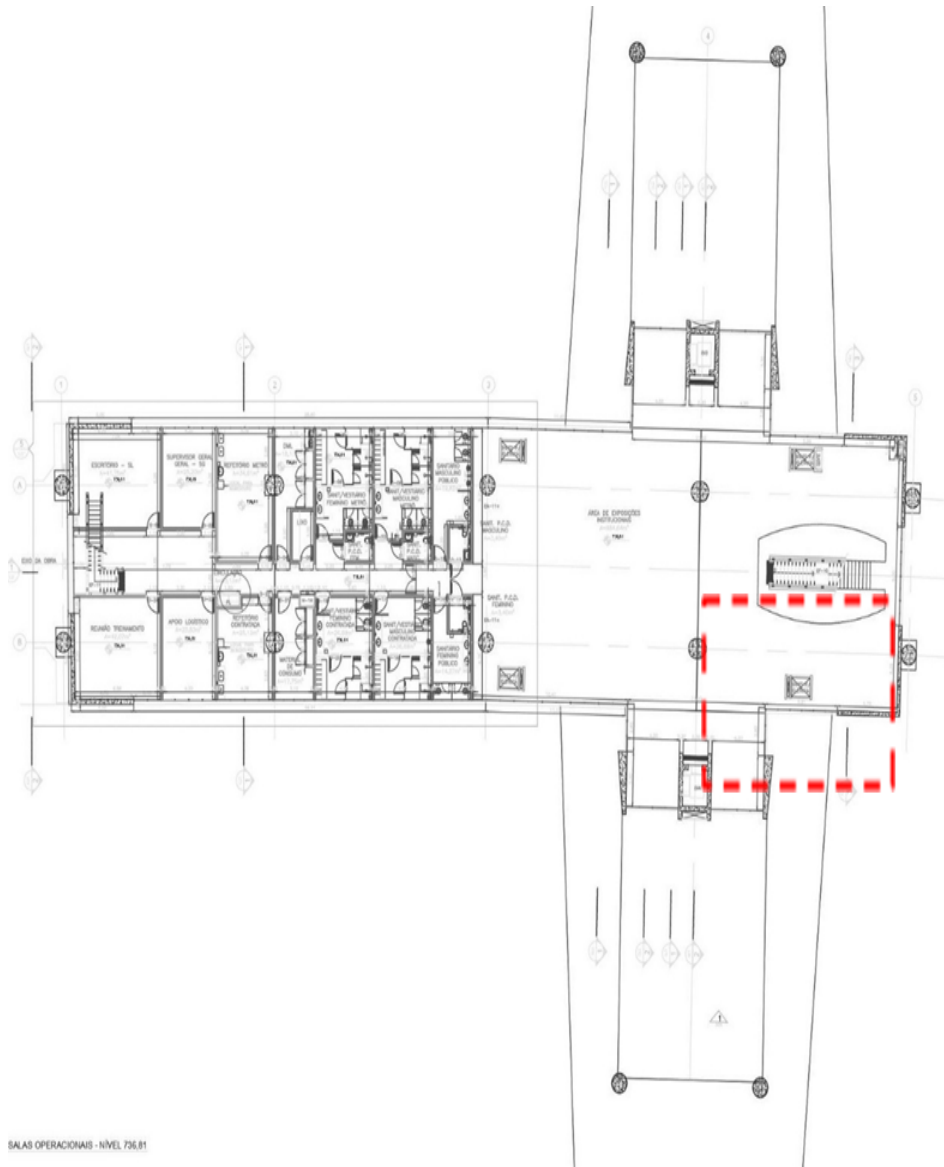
Demarcação da área de intervenção dentro do Pavimento das Salas Operacionais
